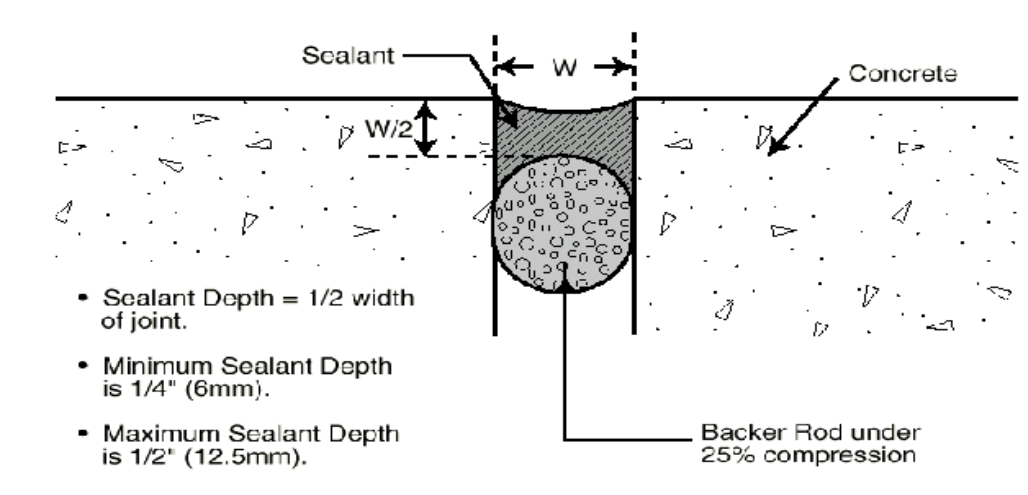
Sello de fisuras. Fuente: construcción de los autores
